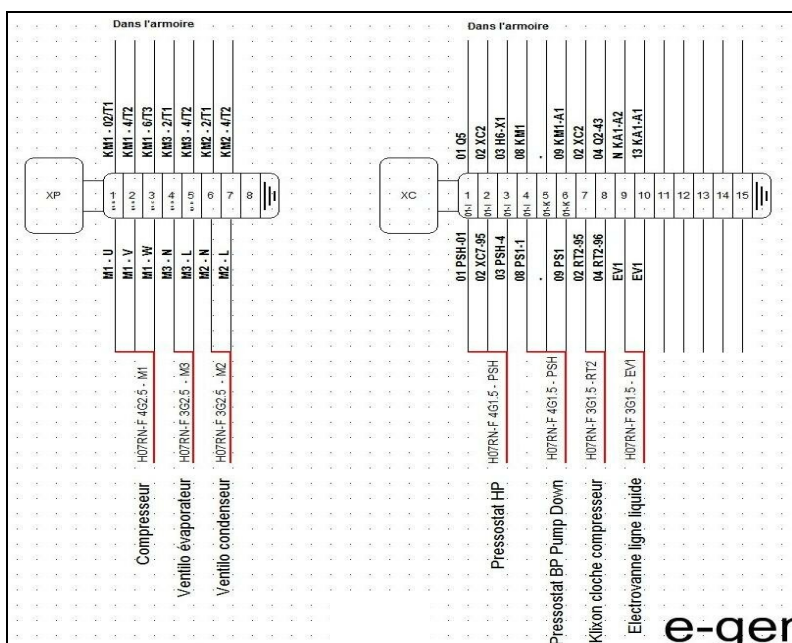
schéma des borniers d'un groupe de condensation-compresseur.
